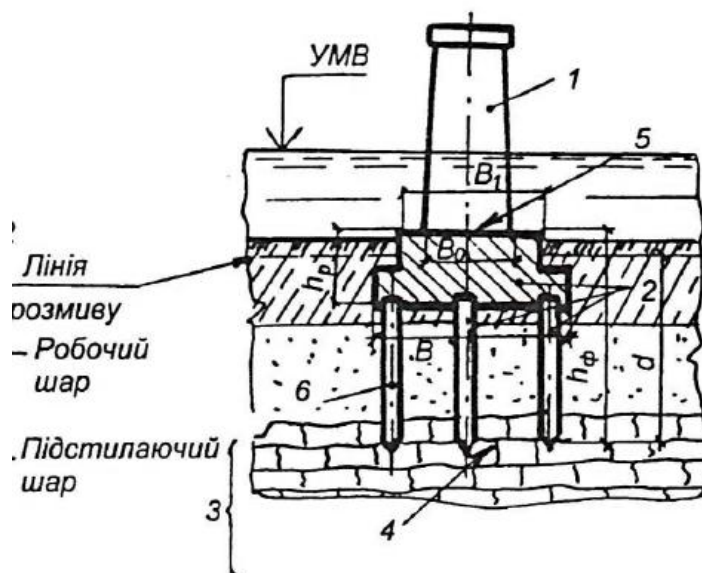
Розрахункова поверхня ґрунту для фундаментів проміжних опор: 1 – надфундаментна частини опори моста; 2 – фундамент; 3 – основа; 4 – підшва умовного фундаменту; 5 – обріз фундаменту; 6 – палі; B – ширина підшви ростверка; B_0 – ширина опори моста; B_1 – ширина обрізу ростверка; h_ϕ – висота фундаменту; h_p – висота ростверку; d – глибина закладання фундаменту
